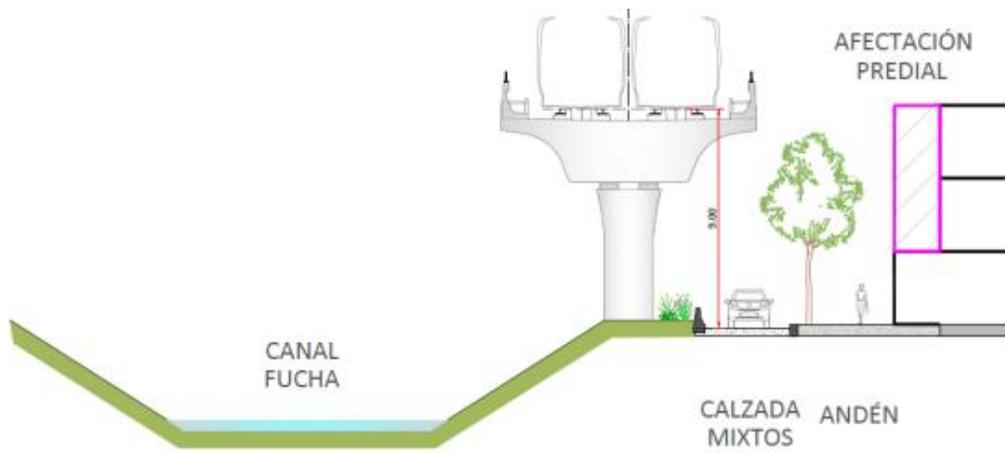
Sección tipo Canal Fucha con inserción lateral, con impacto puntual sobre las fachadas adelantadas – Fuente: SYSTRA
